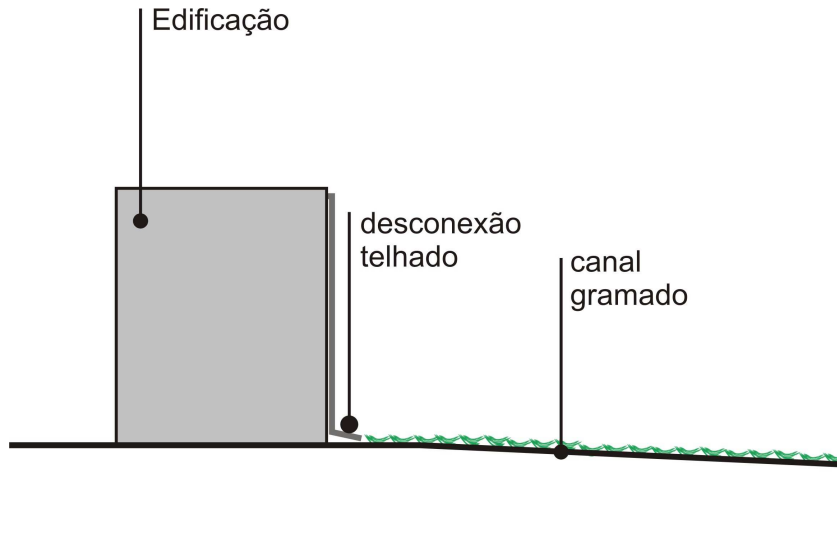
Perfil esquemático de desconexão de telhado.
